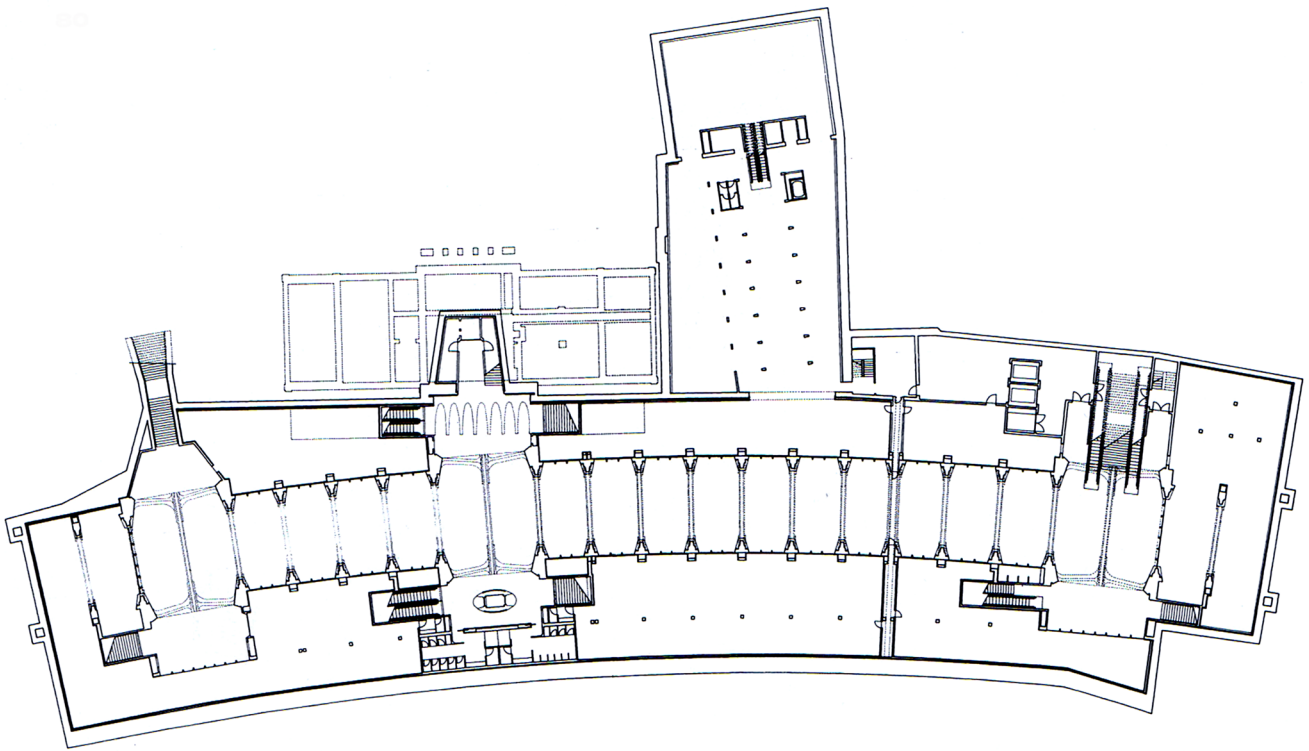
Stadelhofen Station; Grundriss Untergeschoß
